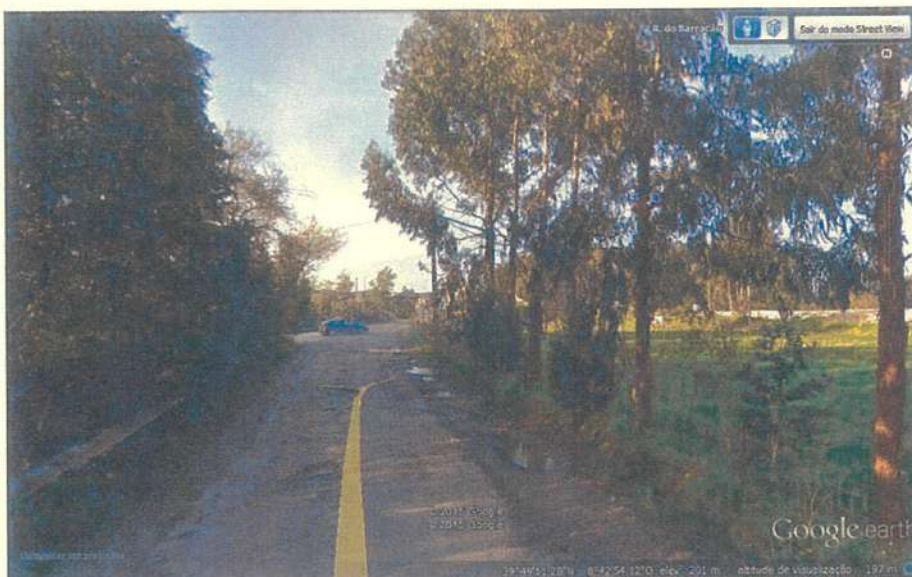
Localidade do Barracão – Via demasiadamente estreita e em mau estado de conservação –
